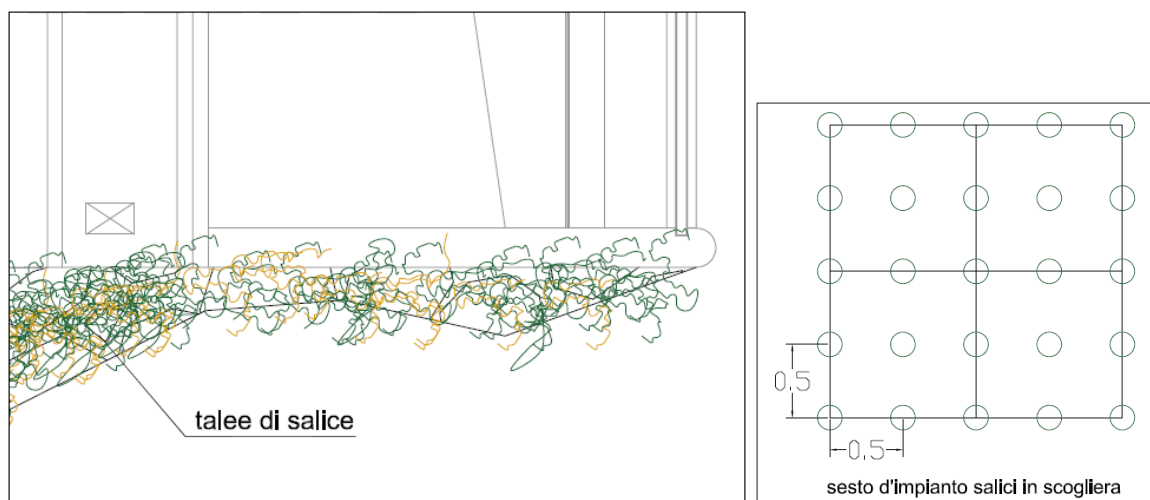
Planimetria di dettaglio e sesto di impianto delle scogliere rinverdite
